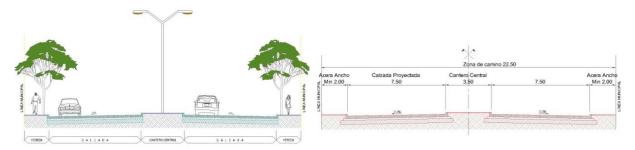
Perfil tipo de un tramo de la Av. Lugones norte, primera etapa, utilizado para el cómputo.
